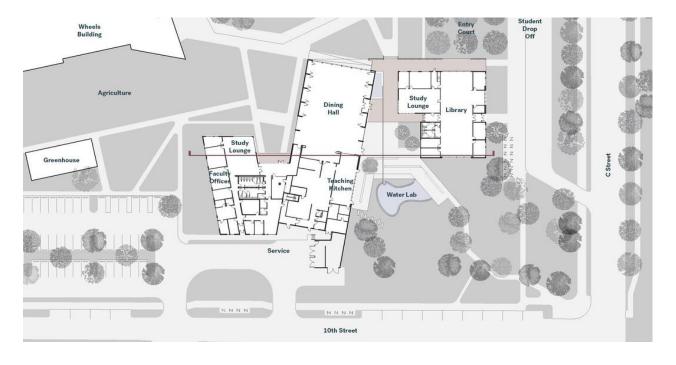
Home Building at Thaden School. Генеральный план. (Источник: archdaily.com)
